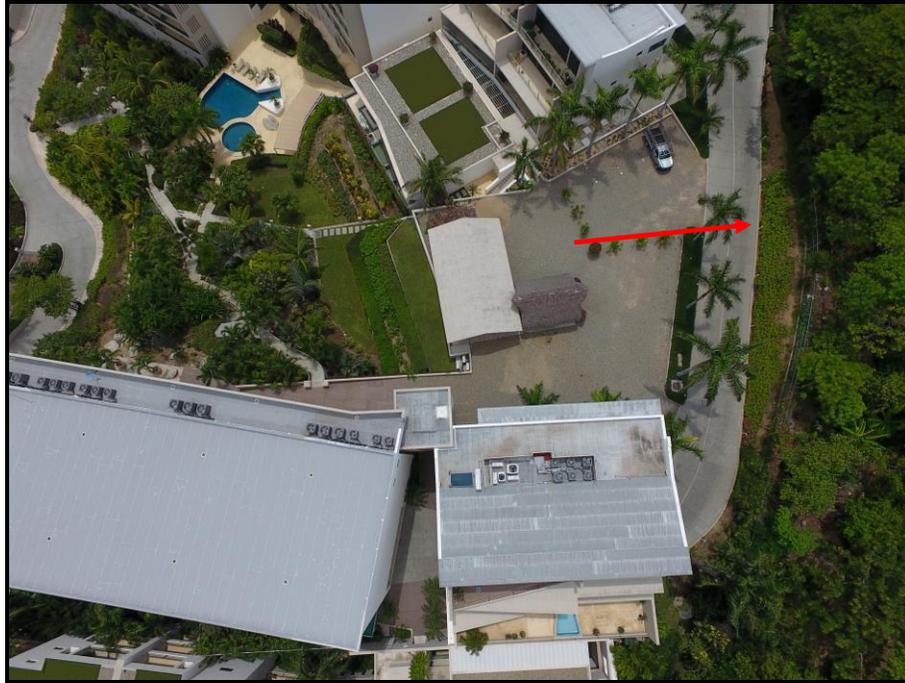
Vista de la colindancia Sur del edificio 11-3, con muro perimetral del terreno y andador construido por FONATUR.
